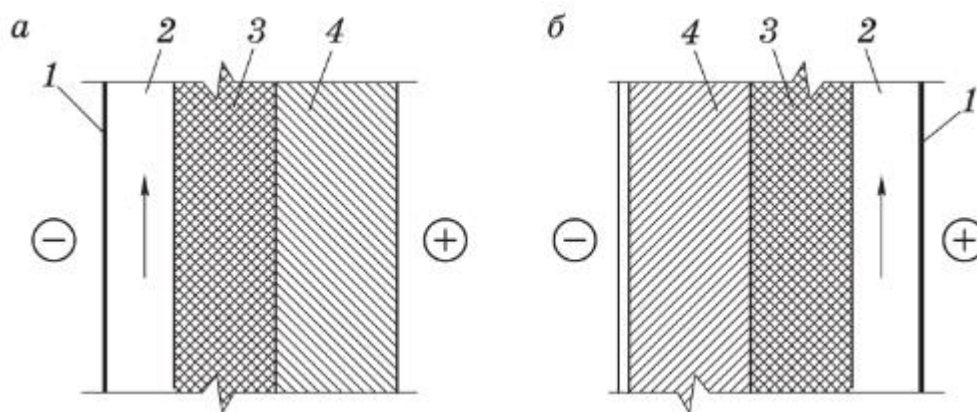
Конструкция наружного утепления с тонким слоем штукатурки
